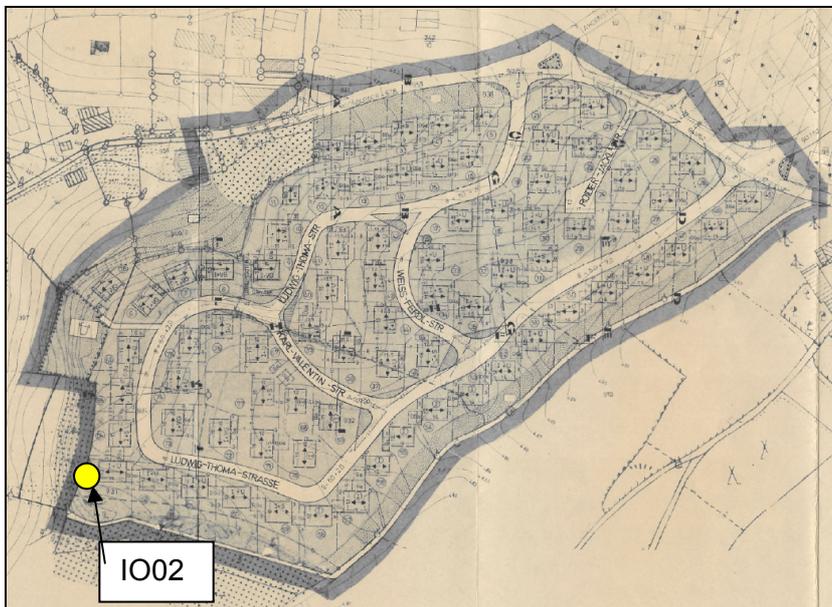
Bebauungsplan Am Kollerhölzl ● Immissionsort
